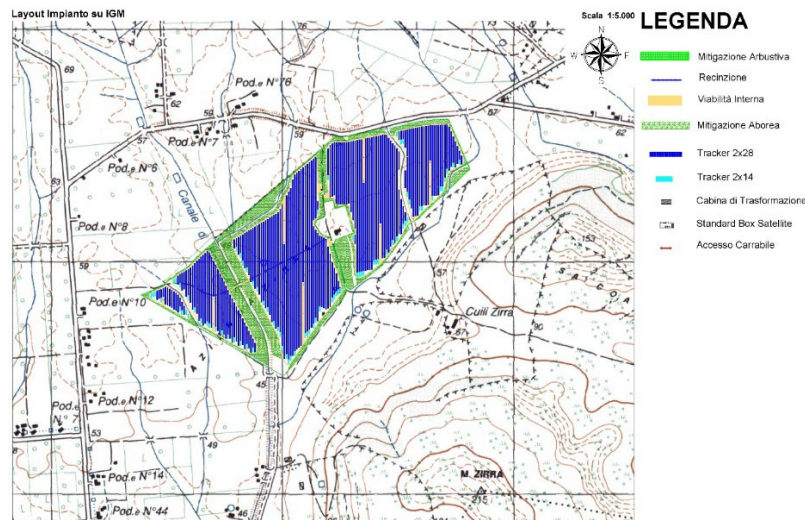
Layout del futuro impianto FV_ SANTA MARIA LA PALMA su I.G.M.
